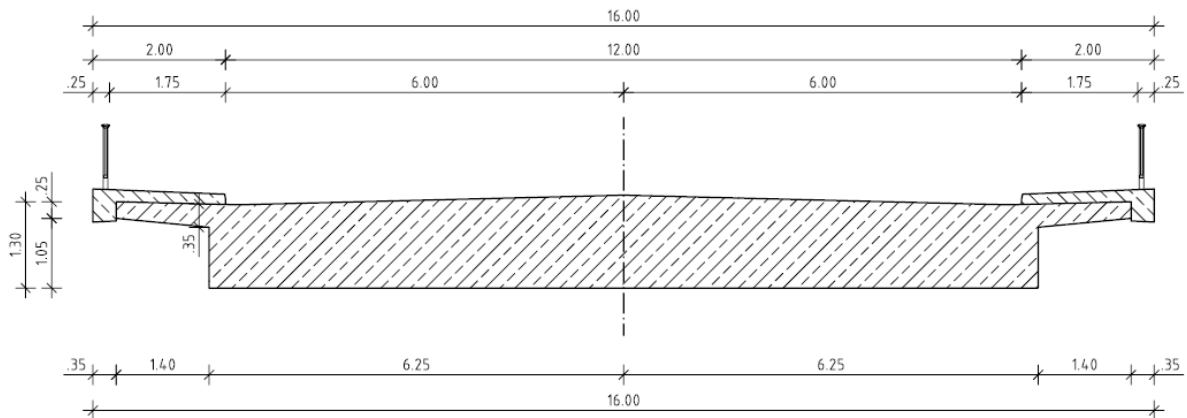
Skizze Plattenquerschnitt in Massivbauweise mit 12 m Fahrbahnbreite
